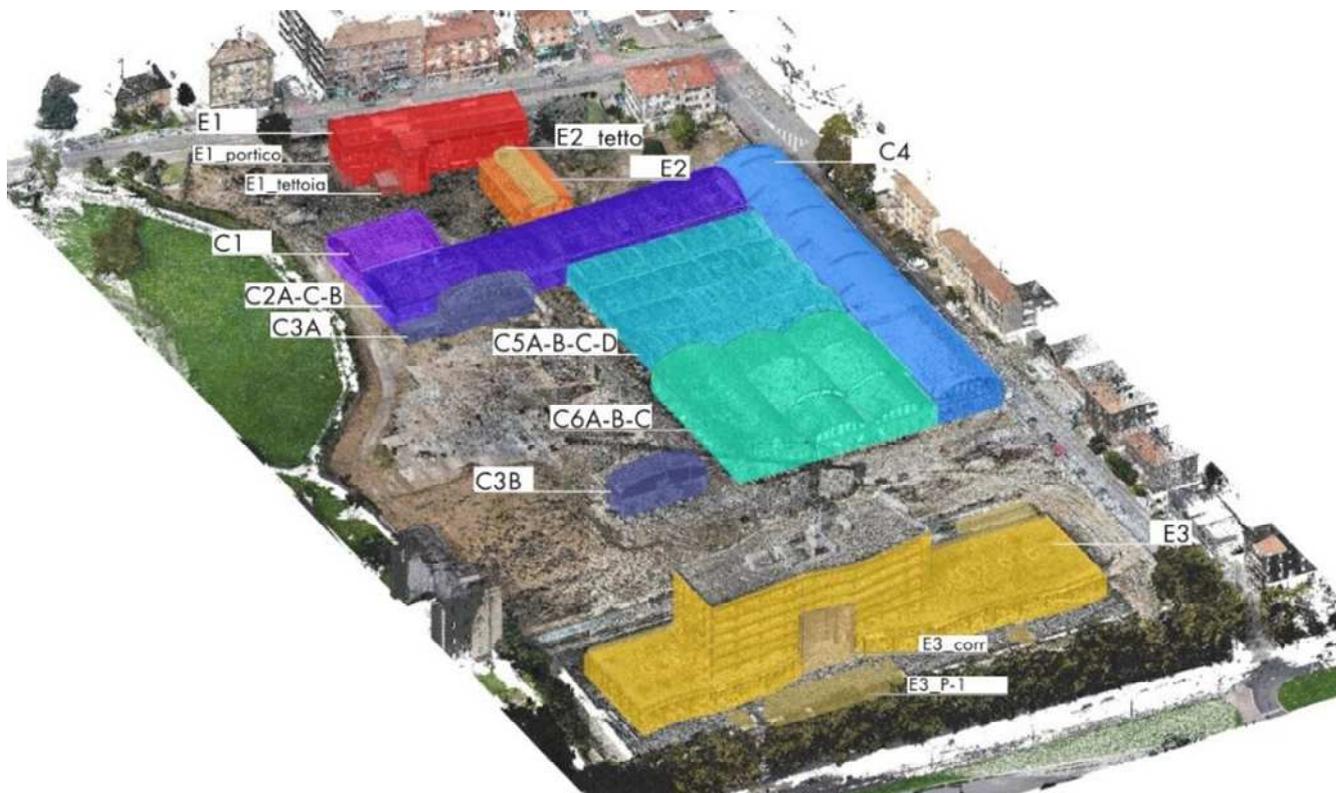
Schema planivolumetrico con individuazione degli edifici
